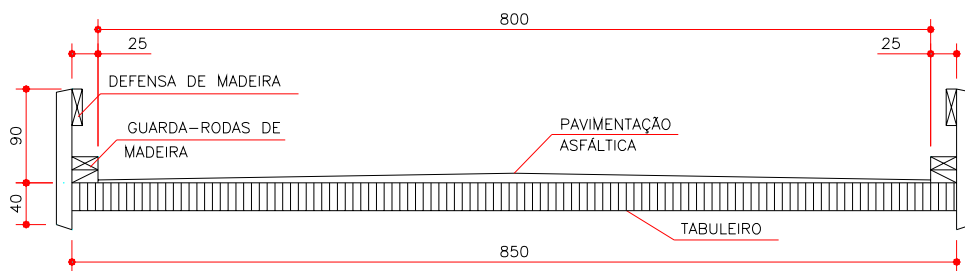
Seção transversal da ponte em placa protendida transversalmente com duas faixas de tráfego
